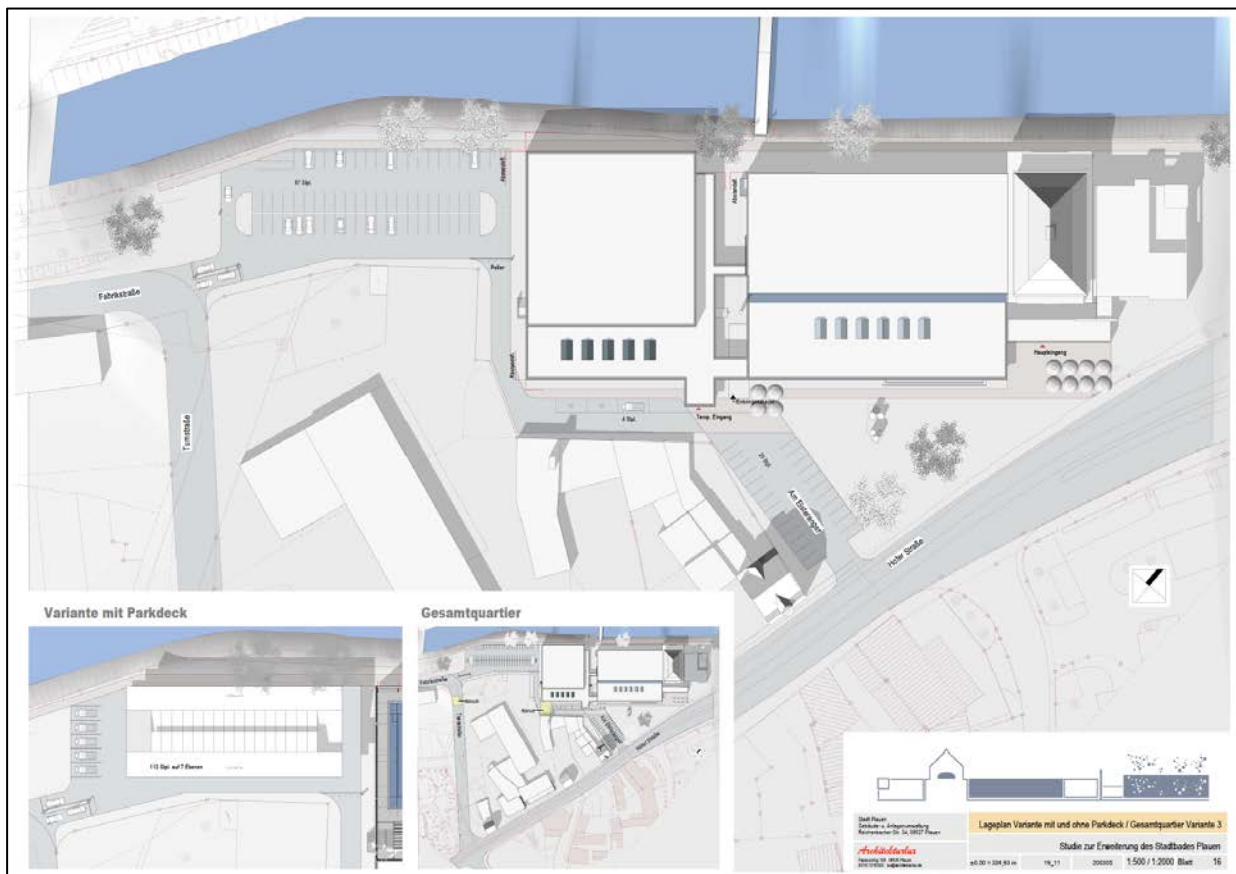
Voruntersuchung zur Einordnung des neuen Baukörpers und der neuen Erschließung
